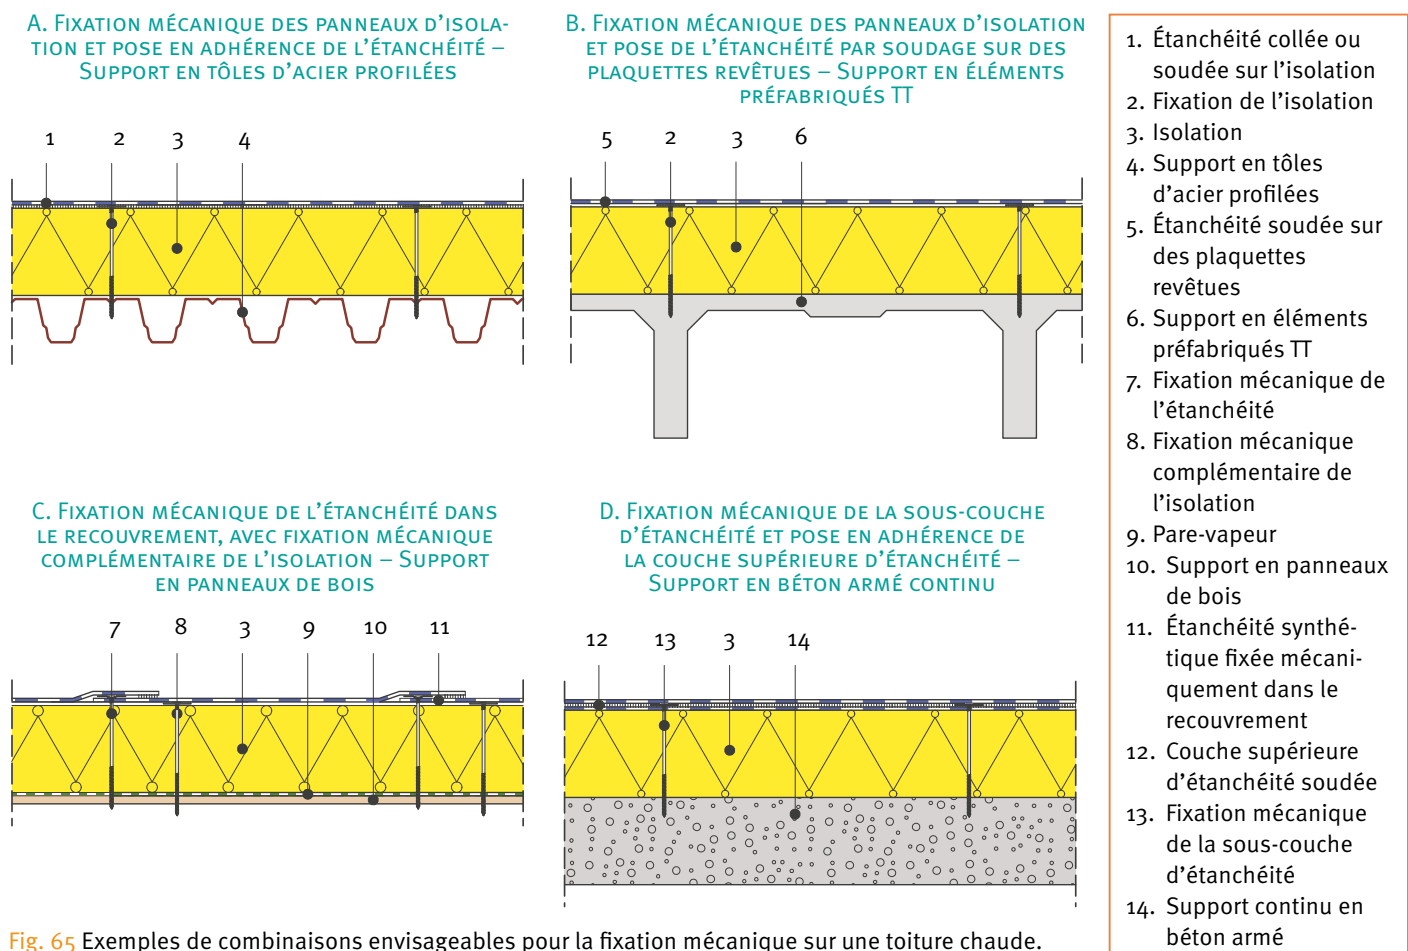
Exemples de combinaisons envisageables pour la fixation mécanique sur une toiture chaude.
